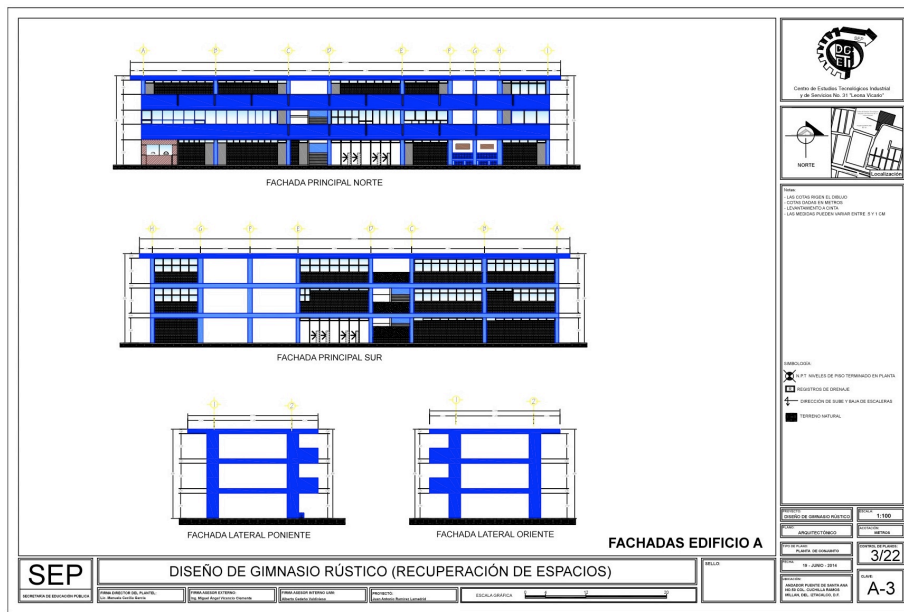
Fachadas edificio A, levantamiento por Juan Ramírez.
